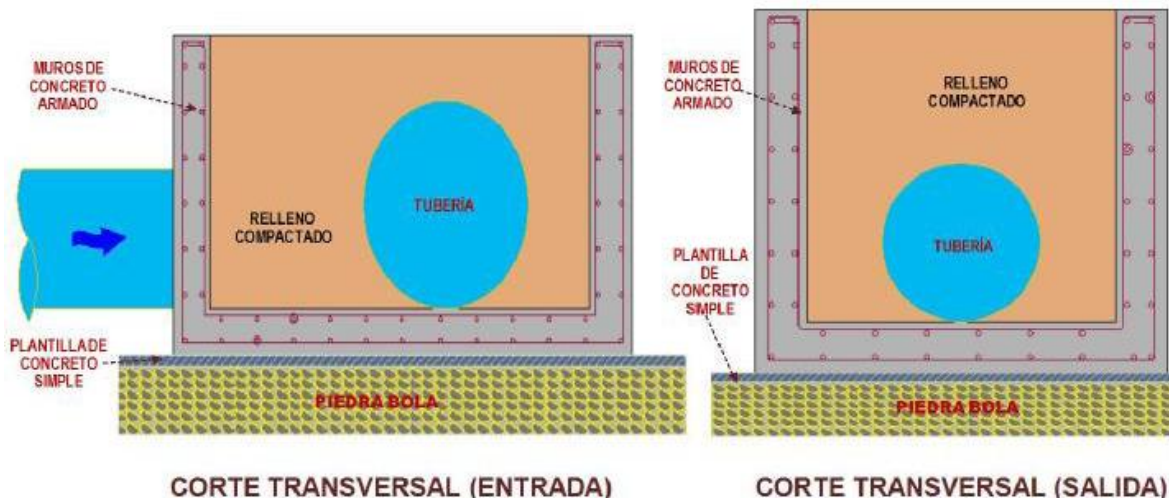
Corte trasversal del puente canal debidamente protegido con mampostería de piedra bola de 30 cm de espesor y con tubo protegido de 30" de diámetro con relleno compactado.
